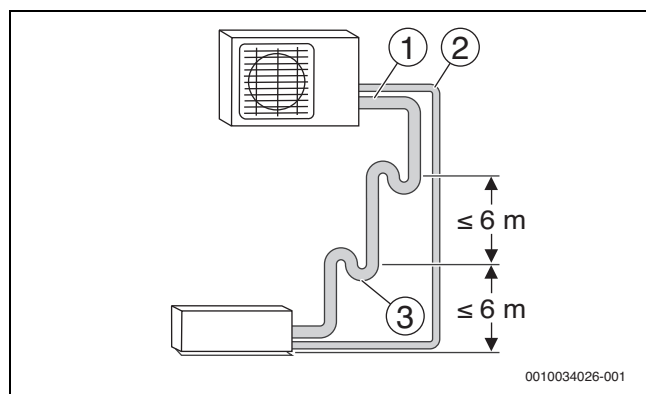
Installazione dell'unità esterna sopra l'unità interna
